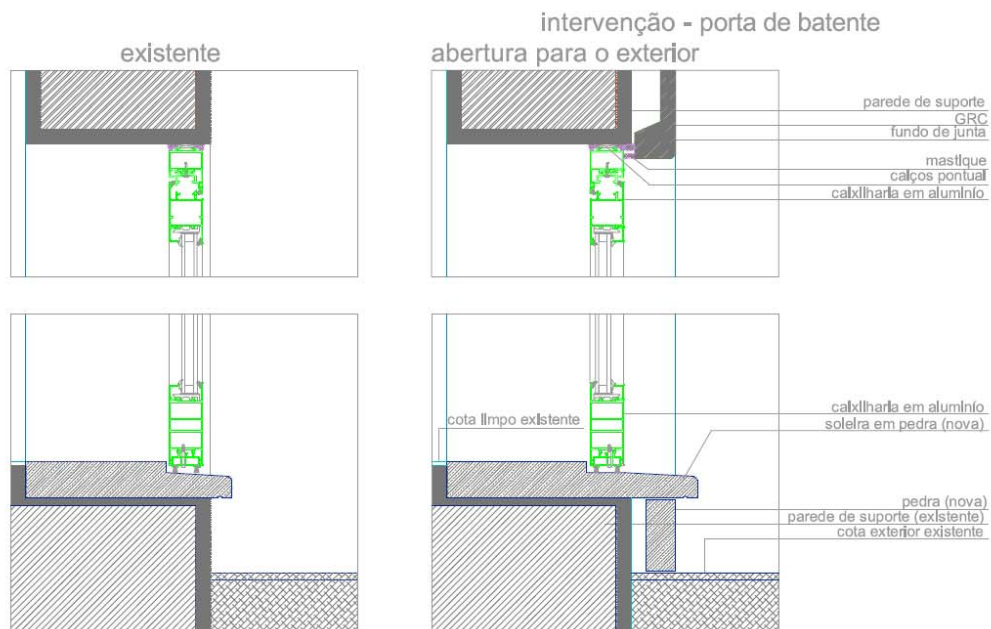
Pormenor construtivo vertical. Entrada (escala 1/10).
